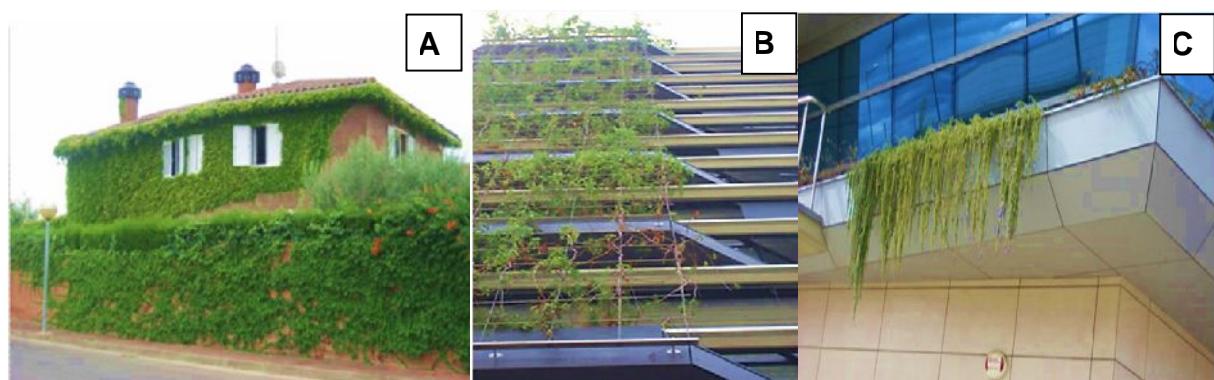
A) Fachada verde tradicional; B) fachada verde ou pele dupla; C) Fachada em vasos de perímetros.
